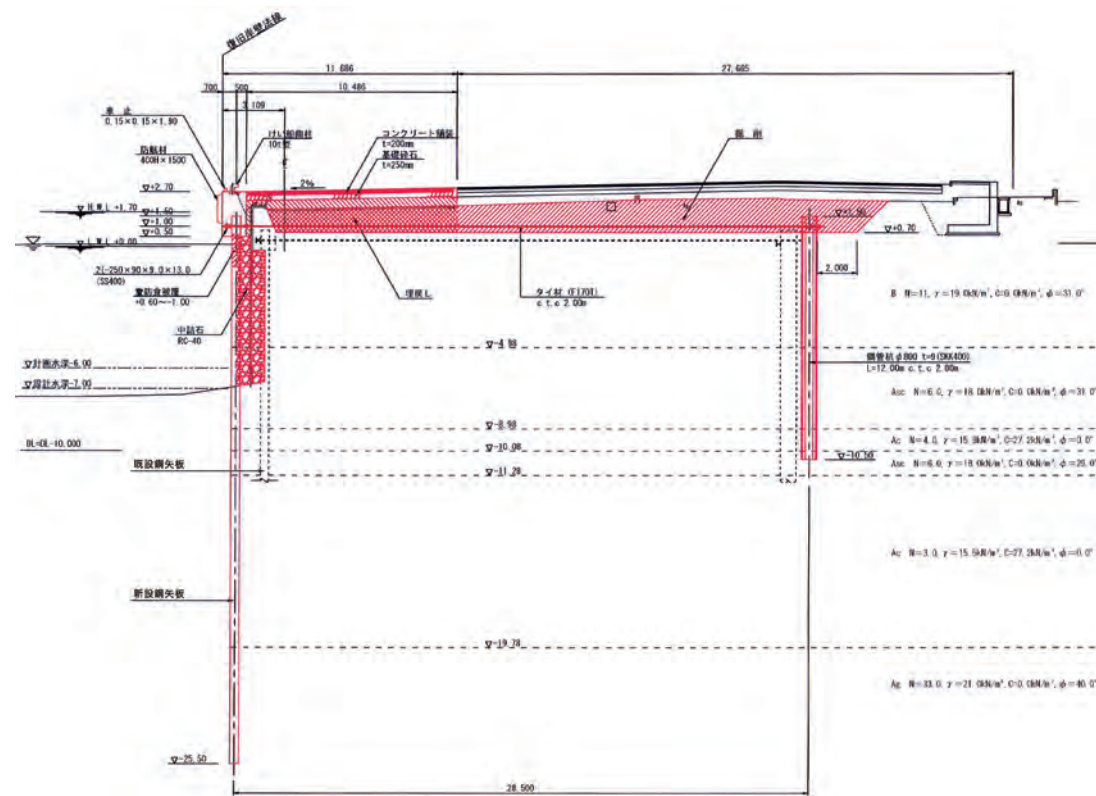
設計水深-6m岸壁 復旧標準断面図
